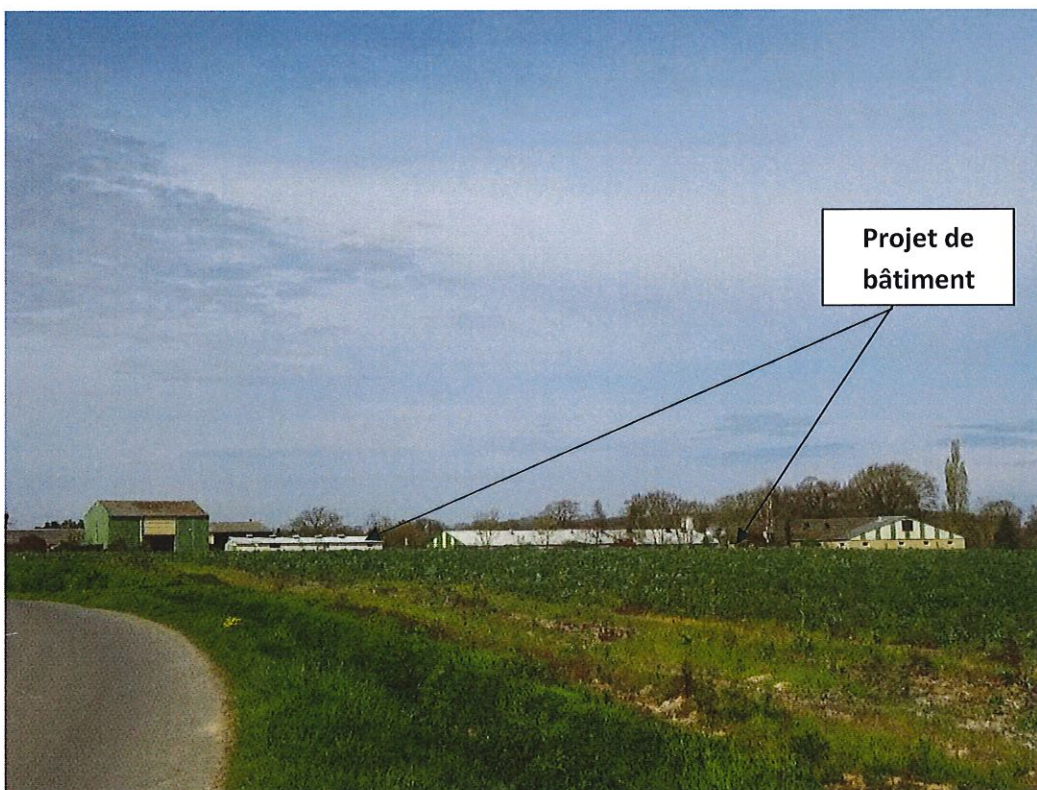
Vue rapprochée du site de la salle LA CHAPELLE THOUARAUULT – Côté Nord-ouest
